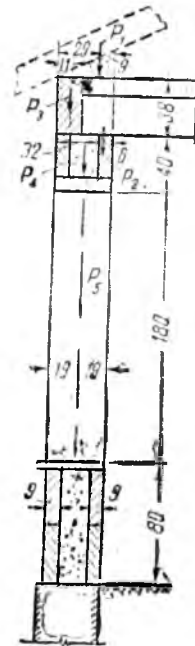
Разрез стены одноэтажного дома с засыпными стенами из бетонных блоков
